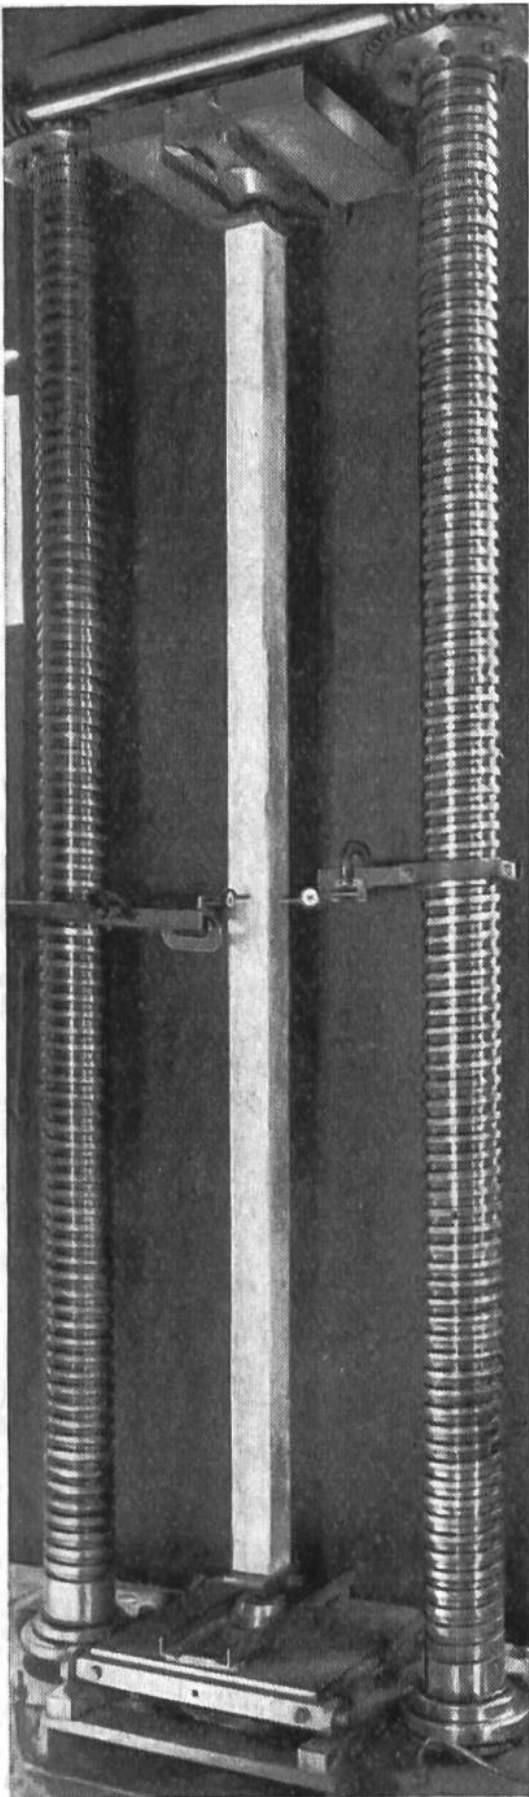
Prüfung eines 3 m langen Holzstabes von 10×10 cm in einer 500 Tonnen Druckmaschine. Gemessen werden der Druck und die seitlichen Ausbiegungen.
